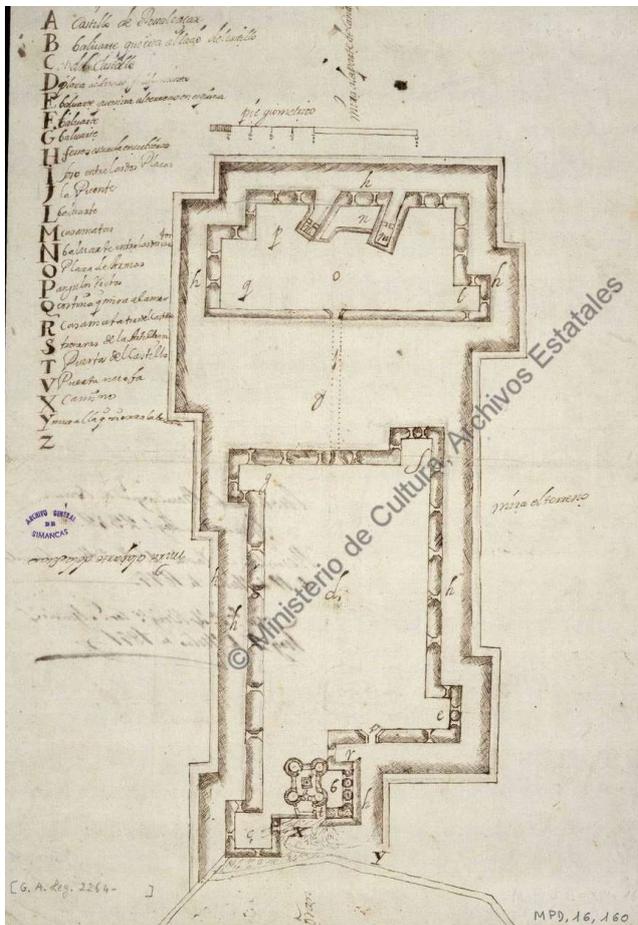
Plano de Rosalcazar de 1675 de Pedro Maurel, (AGS, GyM, Leg.02342, MPD, 16, 160).
